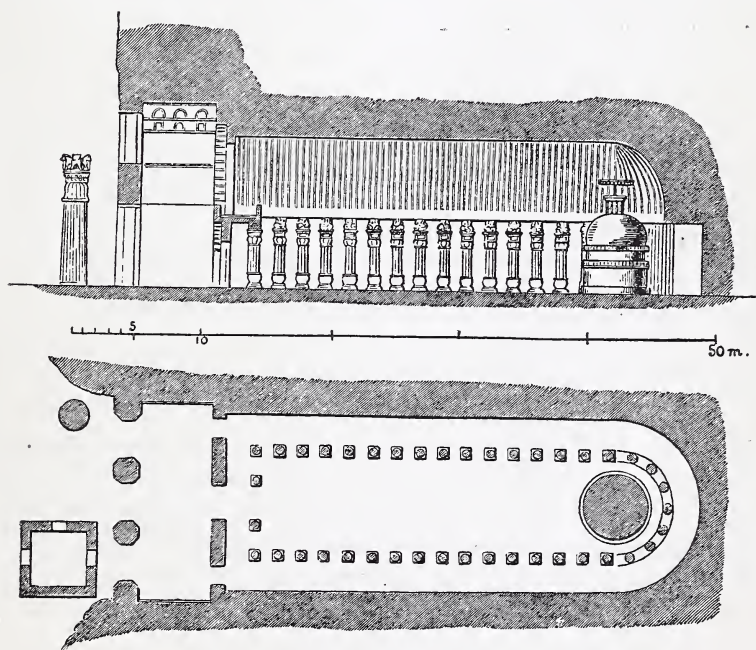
Plan und Durchschnitt der Tschaitija-Halle zu Karli.
